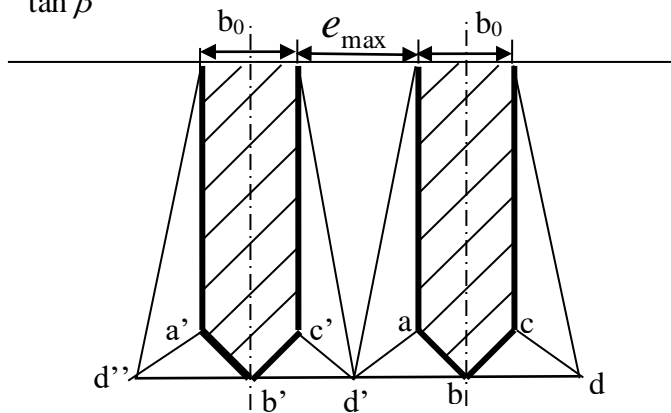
Espacement maximal pour que les prismes de rupture de sol au niveau de la pointe se touchent (coupe transversale)
